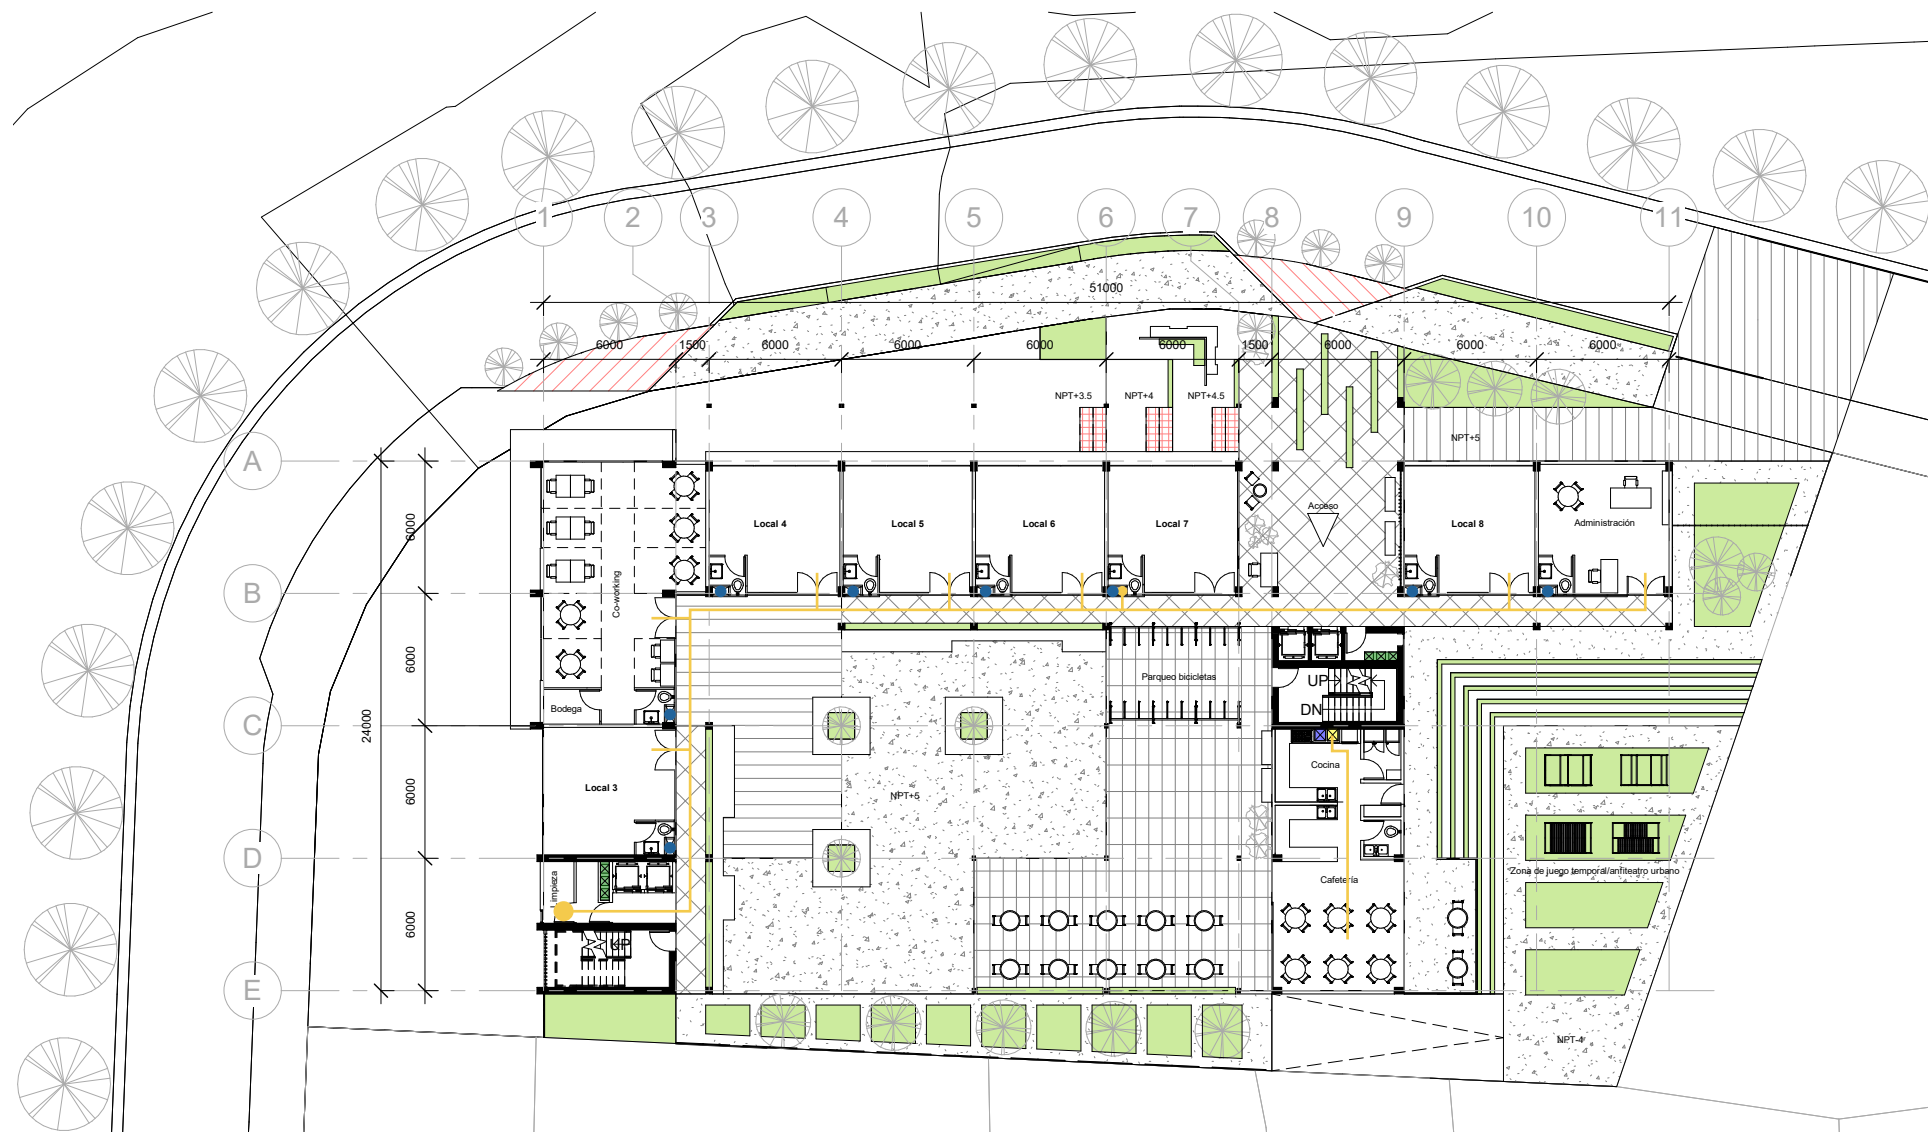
Planta nivel 1. Fuente: Elaboración propia.
